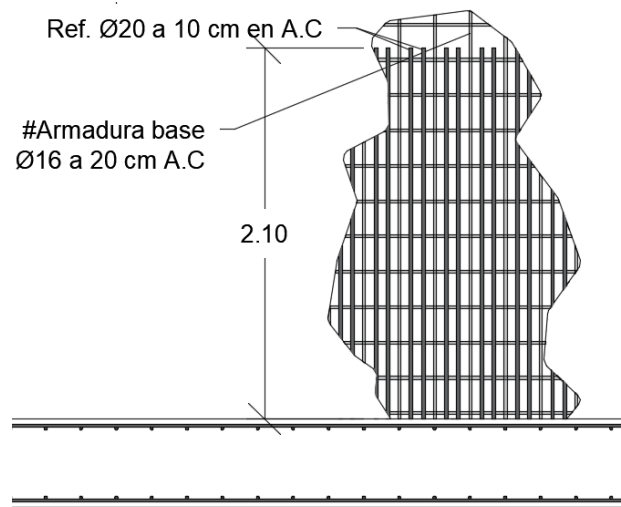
Refuerzo sobre armadura base en Muro Interno 3 (armadura vertical)
